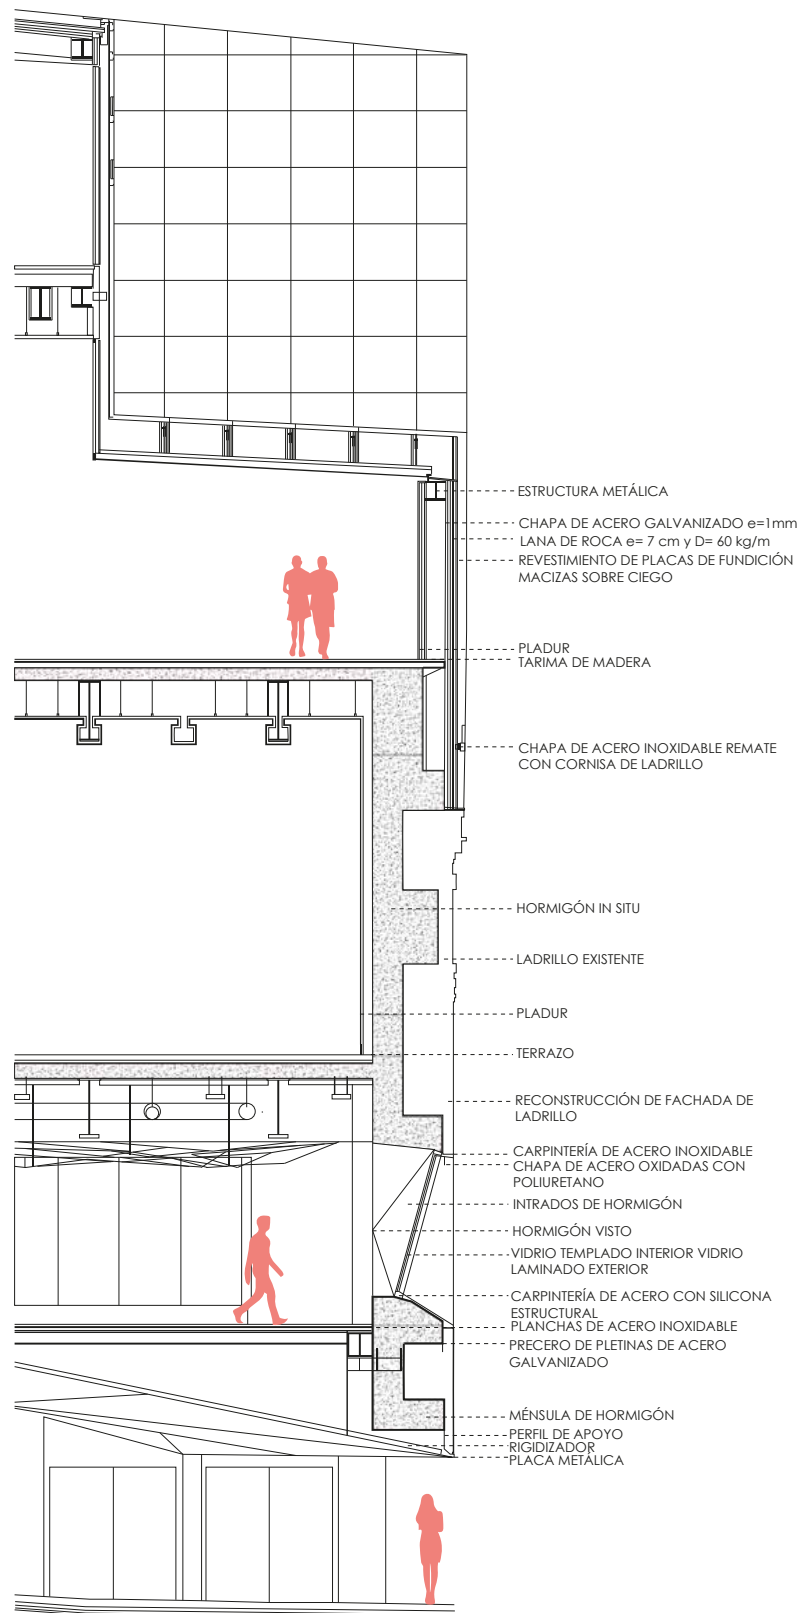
Detalle constructivo CaixaForum. Elaboración: Autora
